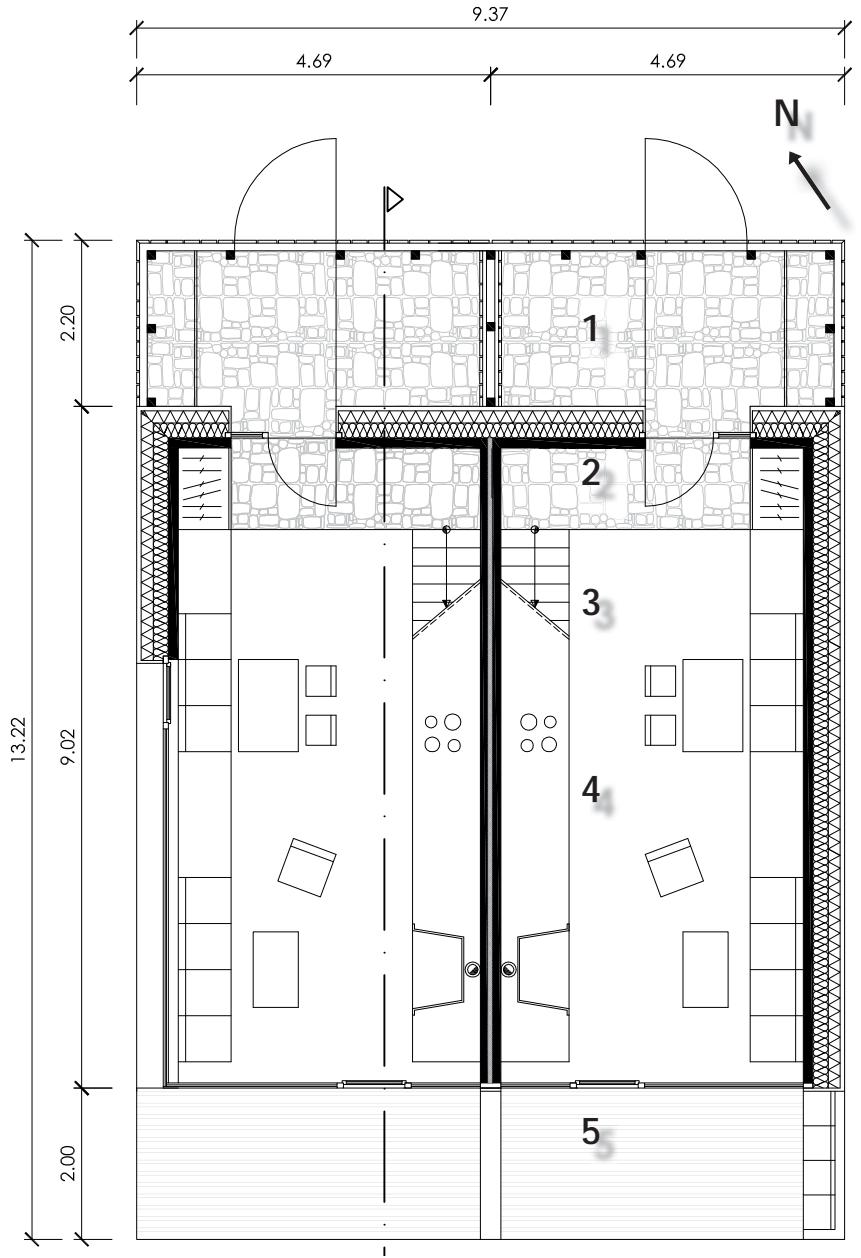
Grundriss EG - Haustyp 1 - M 1:100
